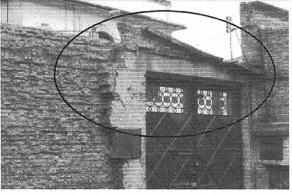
Colapso parcial del muro y desprendimiento de unidades de mampostería zona superior
